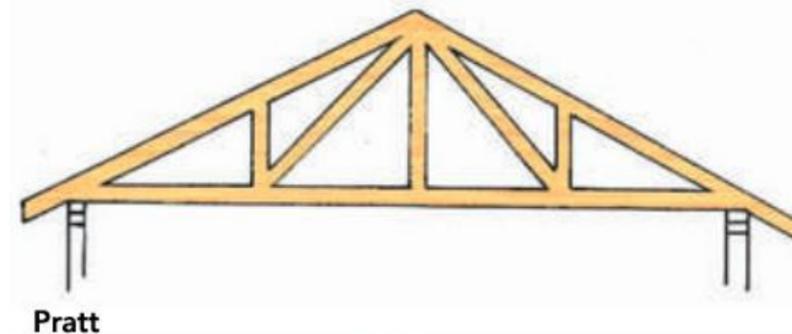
Estructura de Techo. Fuente: Manual de construcción de viviendas de madera (Chile) Unidad 11 –estructuras de techo
